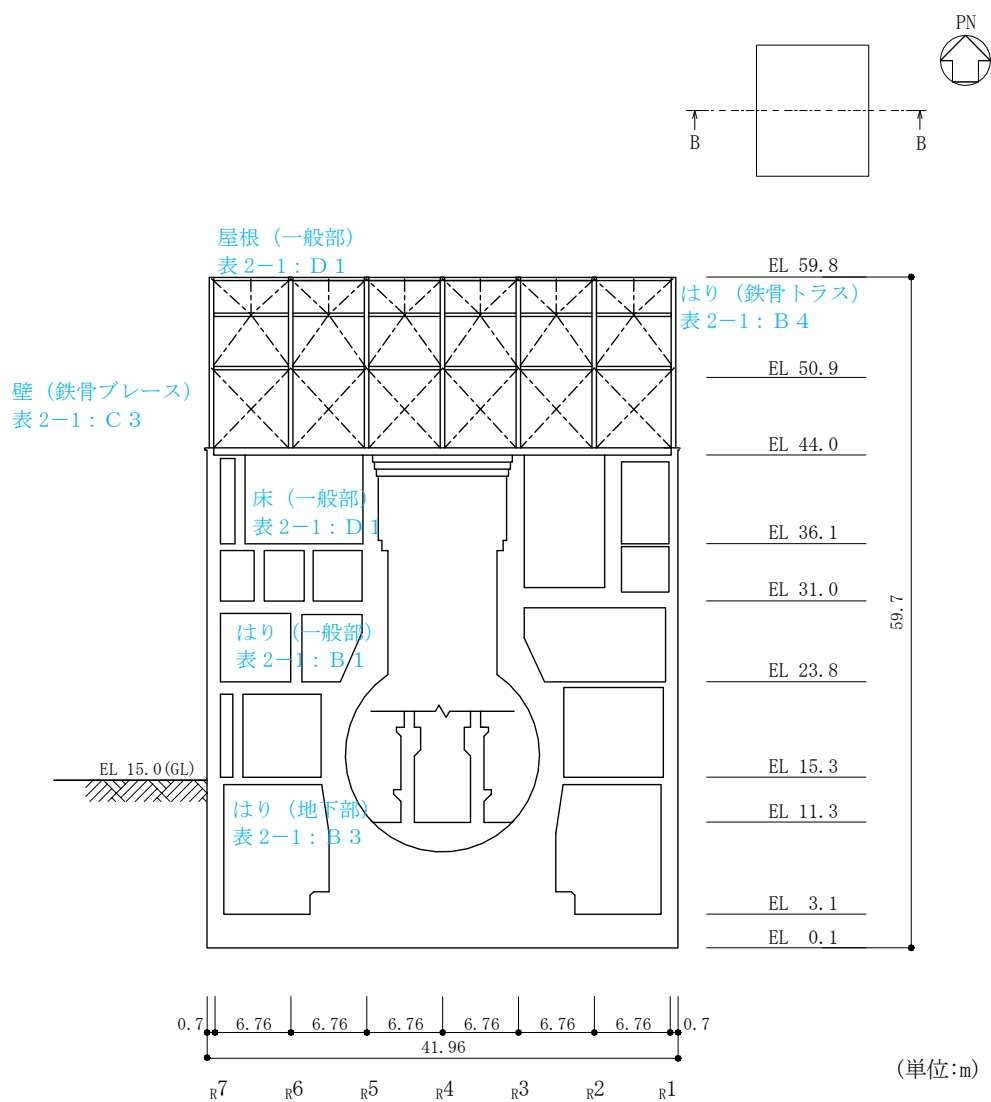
(2) 1号機原子炉建物の概略断面図 (B-B断面, EW方向)
